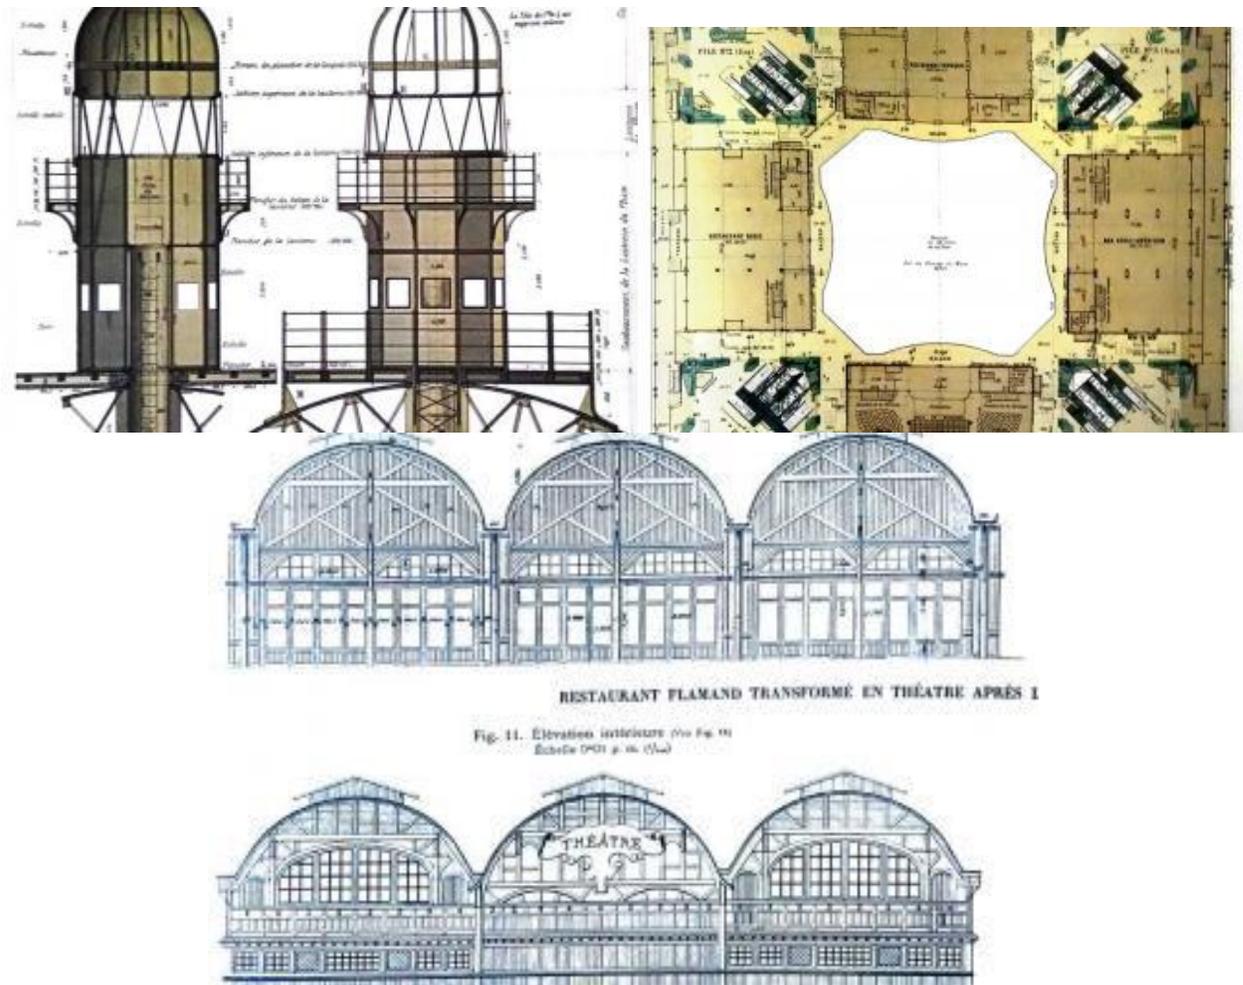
Detalles constructivos de la torre. Fuente: *The Eiffel Tower*, Taschen
